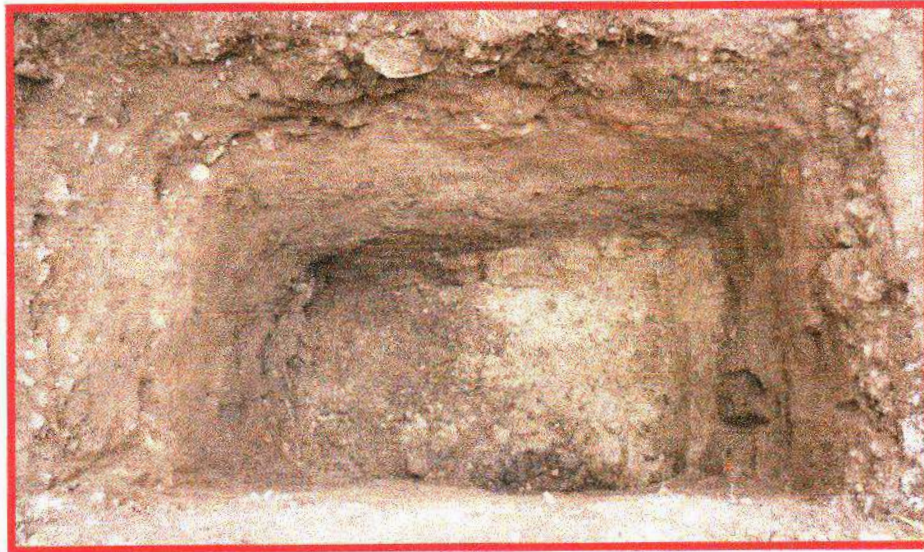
Detalle del perfil del suelo en calicata C-4.
